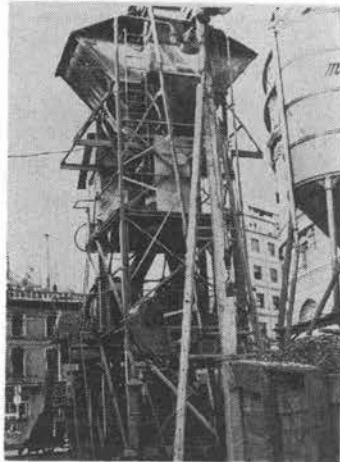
コンクリートプラントドラムミキサ2台で空線をする
